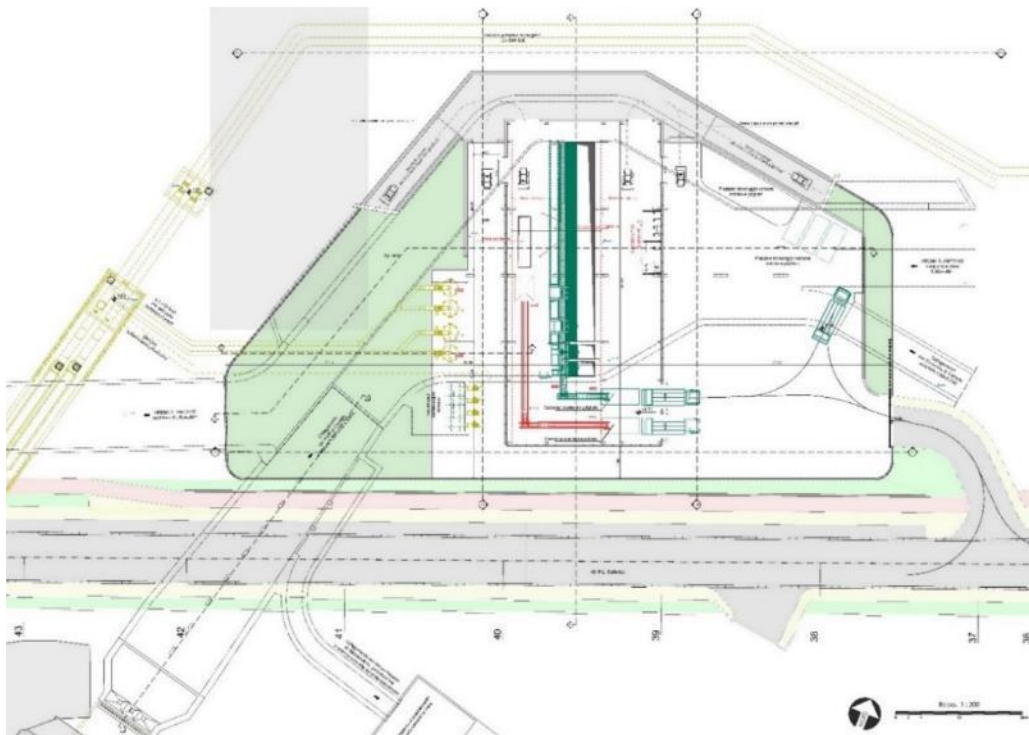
Nuovo impianto di grigliatura media – Pianta q.ta +15
